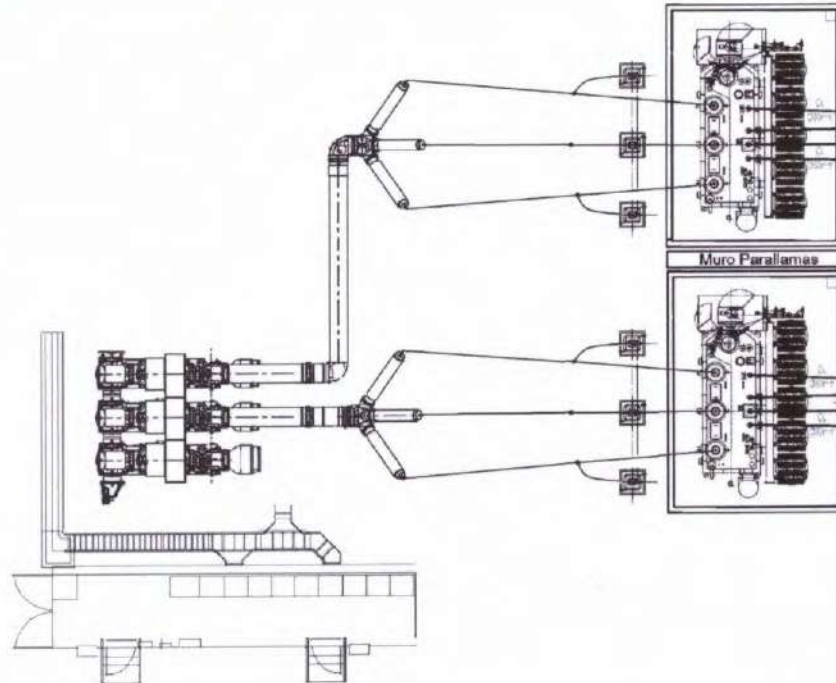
Layout preliminar ET SIDERSA – GIS 132 kV
